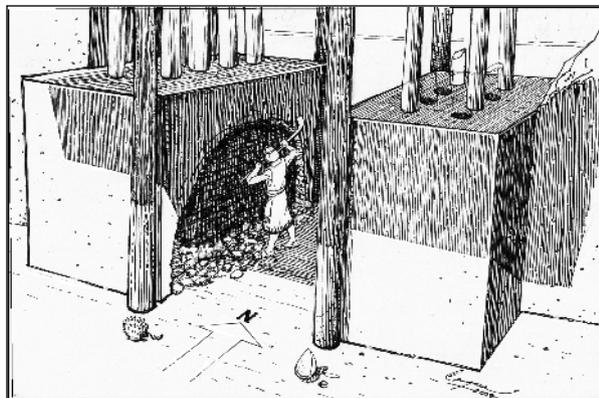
Detalle interior del pórtico. La cubierta del pasadizo estuvo montada en 4 columnas desde el piso y en dos columnatas de 8 y 8, en cada uno de los machones. En las jambas se abrió un boquete para hacer las hornacinas.
